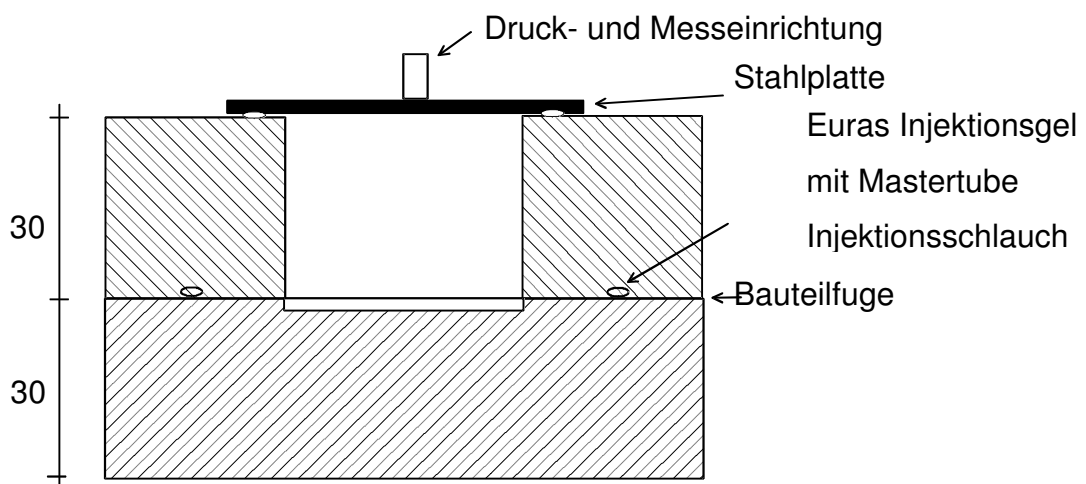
Detailskizze zur Prüfanordnung – horizontaler Schnitt
